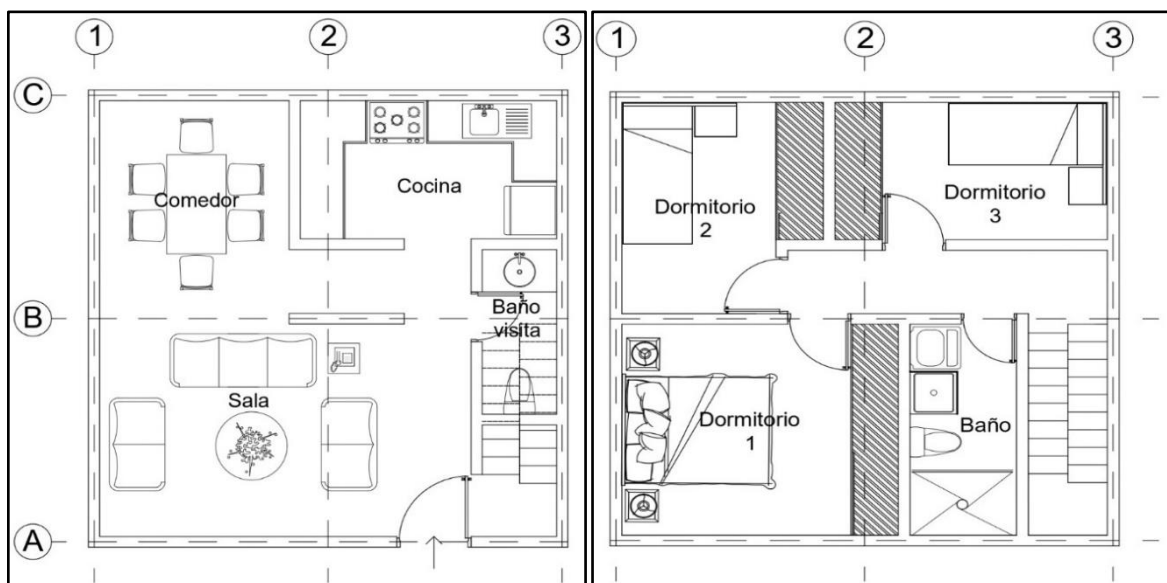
Figura. Vista de 1era y 2da planta de edificación modelo, respectivamente.
